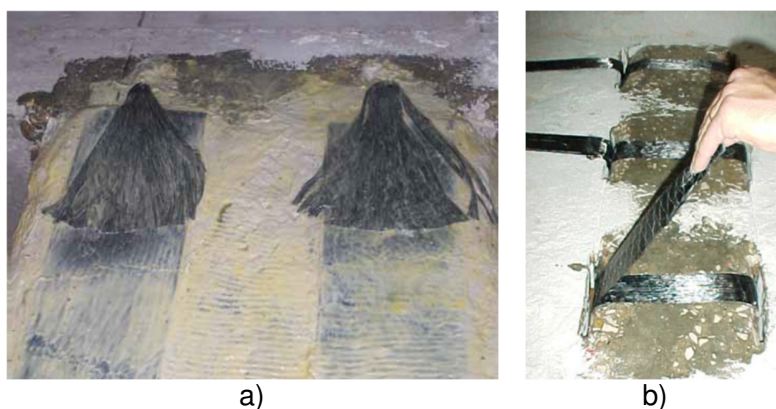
Reforzamiento a cortante una viga de hormigón armado: a) conectores en abanico; b) Franjas pasantes en la parte superior de las vigas.
